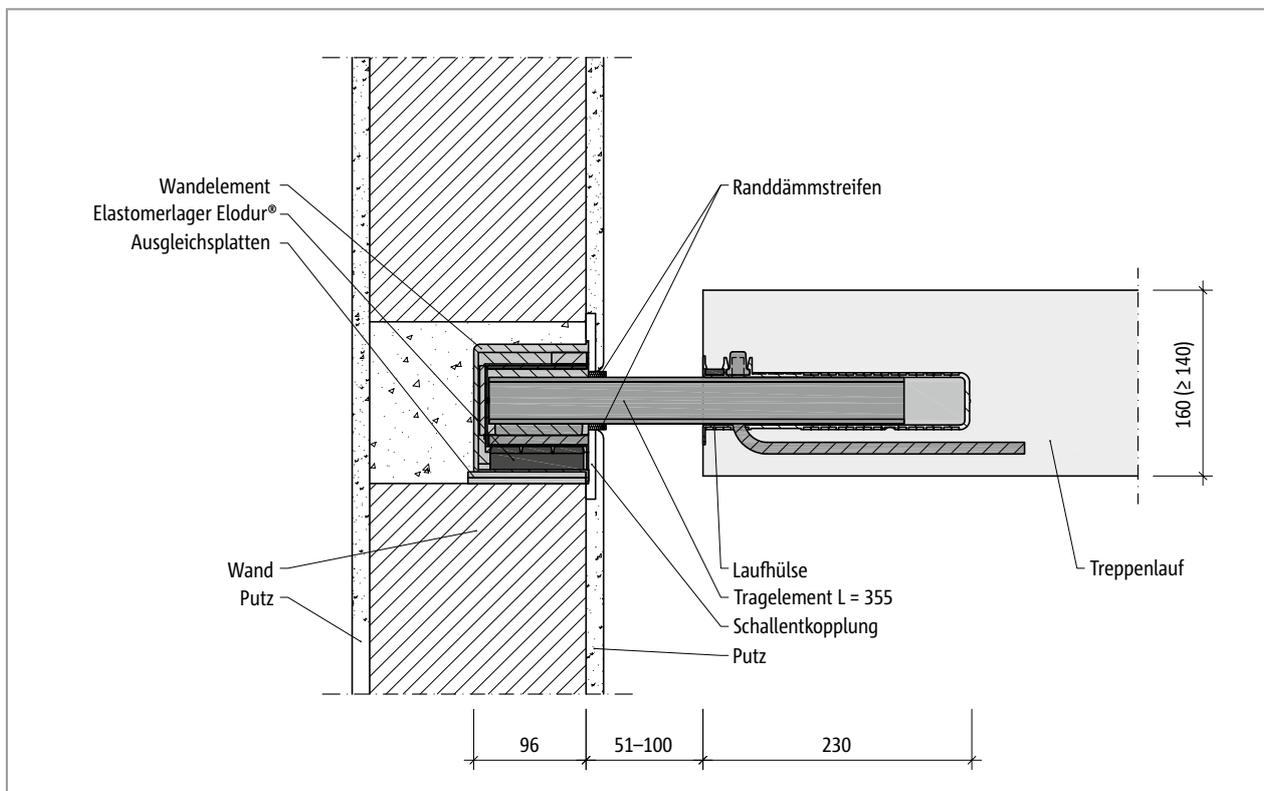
Schöck Tronsole® Typ Q-FV-XL oder Q-A2-XL: Einbauschnitt mit Fertigteiltreppenlauf
